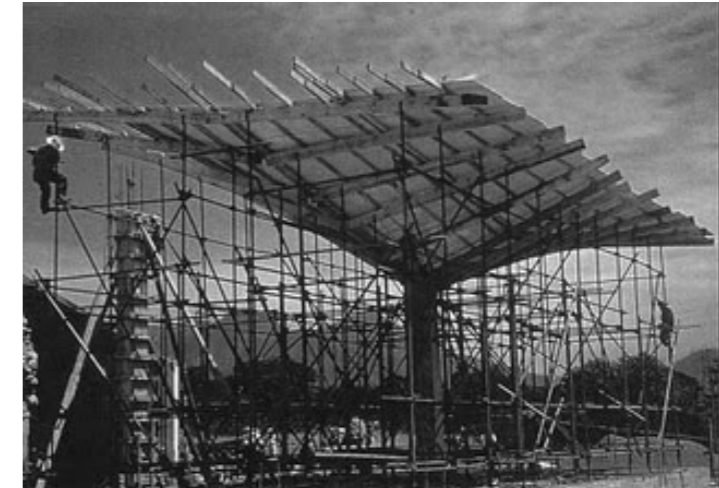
Foto Unión pilar-paraboloides hiperbólicos
